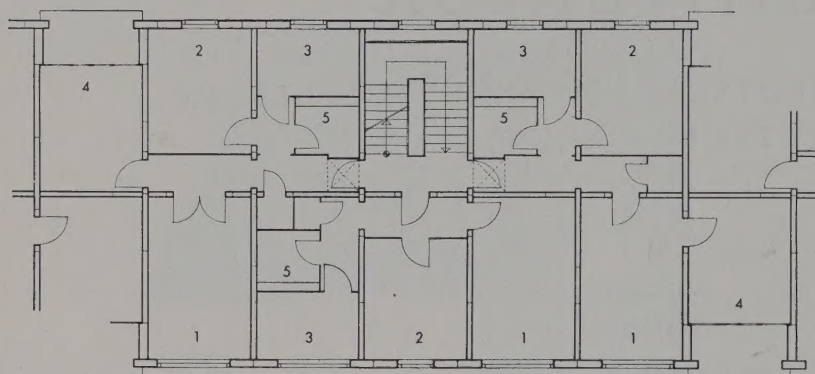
Dreispänner-Grundriß mit zwei 3-Zimmerwohnungen und einer 2-Zimmerwohnung für Querwandbauweise
